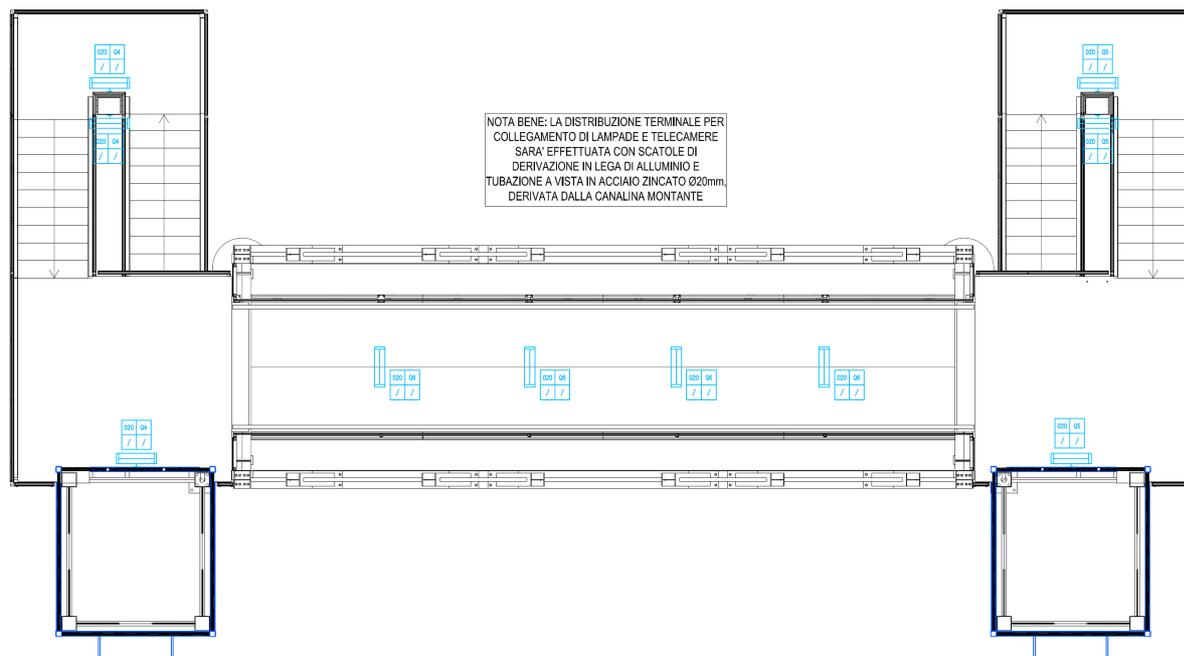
Estratto planimetria impianti elettrici impalcato passerella
